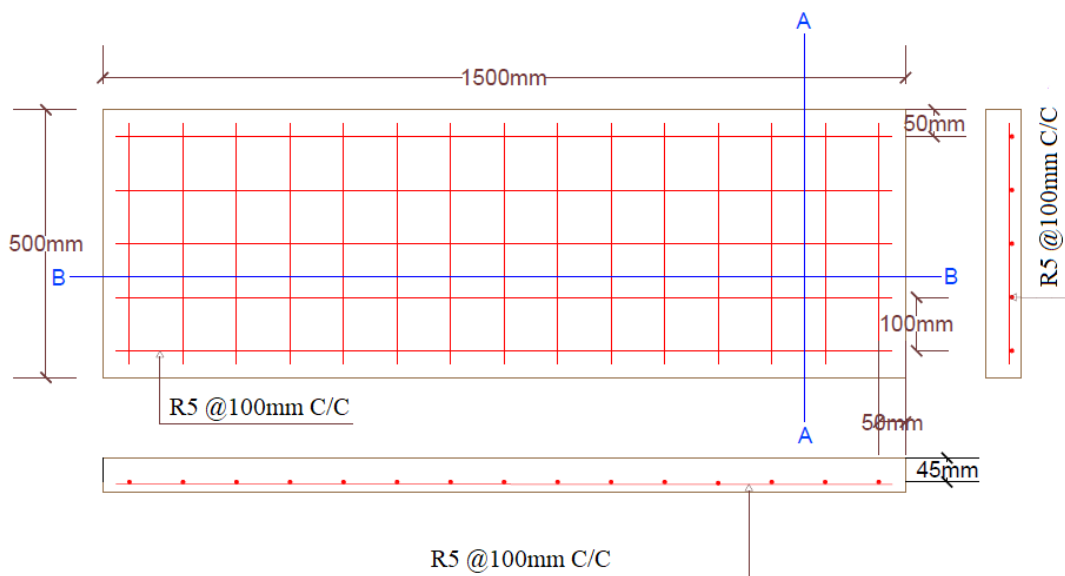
Макет керамзитобетонной плиты перекрытия с базальтовой арматурой
